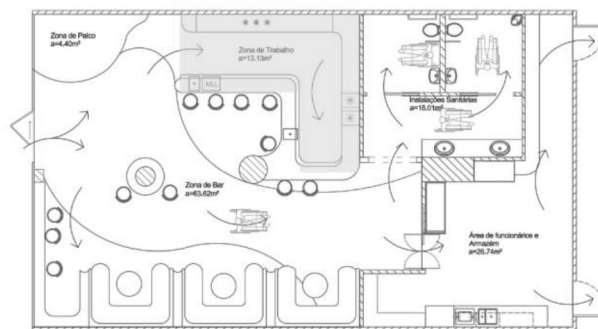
Identificação da Zona de Trabalho em planta (Camila Schmidt,2025)
